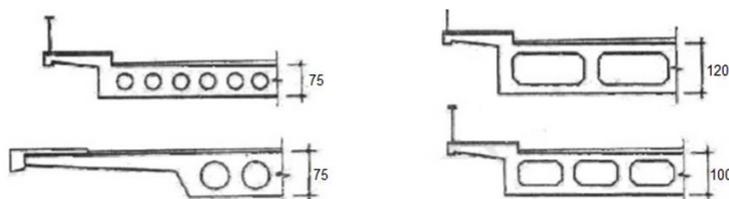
Différentes sections en dalle élégie pour un pont dalle
